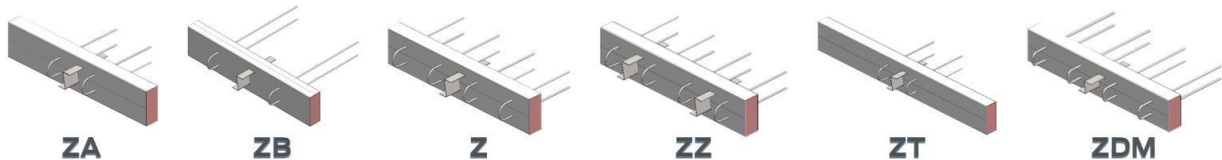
Vue 3D des modèles de traitement des linéaires dalle pleine – façade – Procédé Slabe 8
